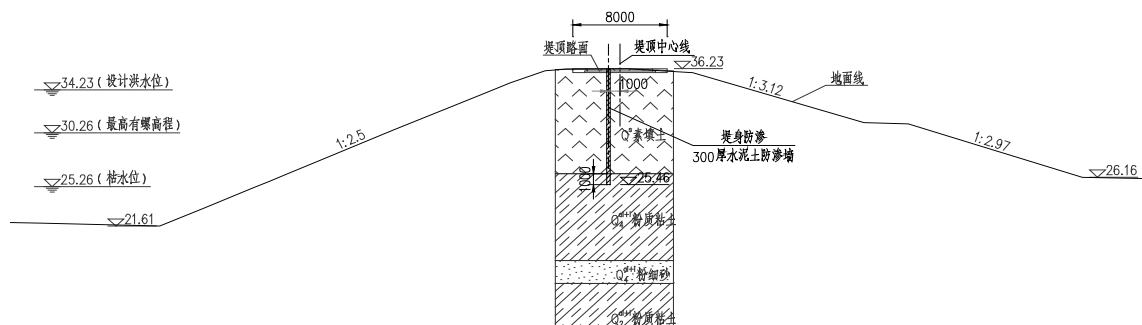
水深层搅拌泥土防渗墙典型断面图
